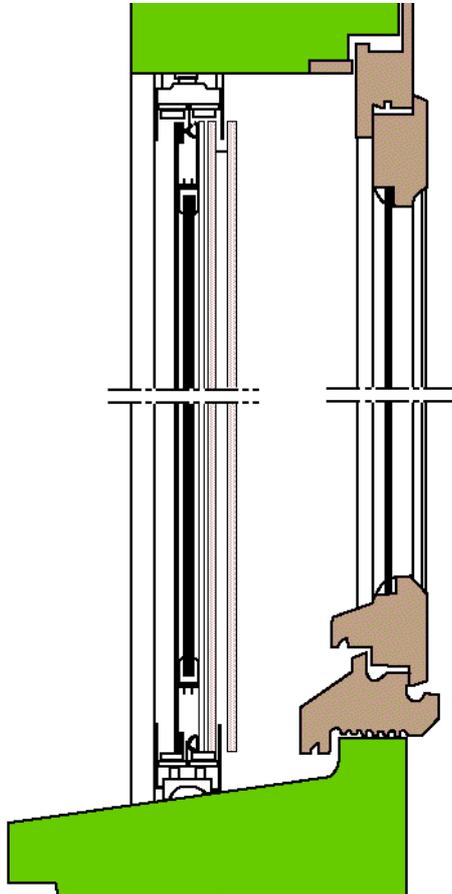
Fenêtre de doublage coulissante en aluminium – vue en coupe
